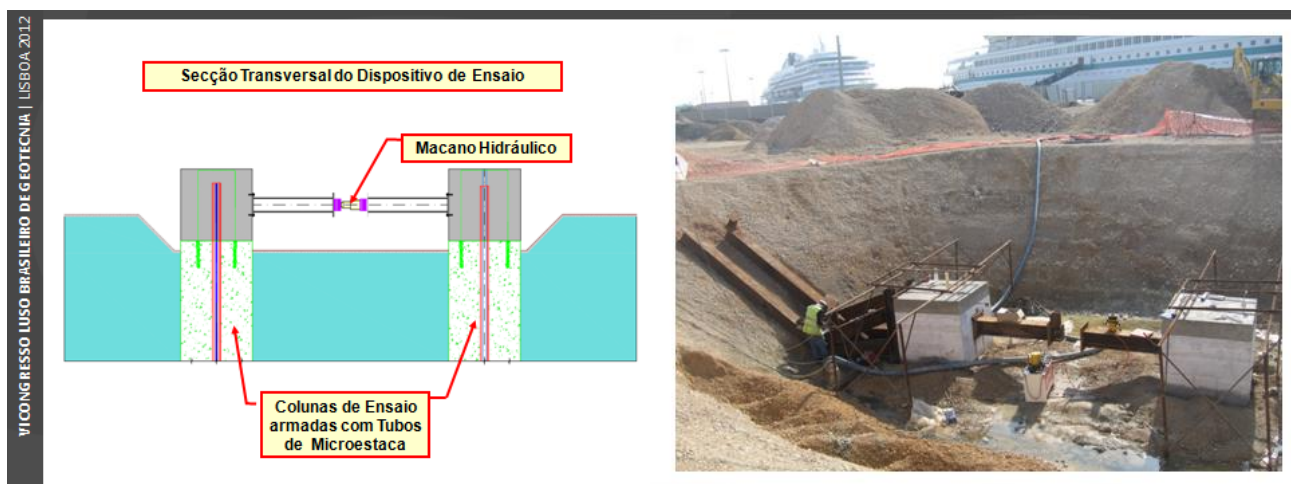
Sistema de Ensaio Idealizado e Sistema Alternativo Implementado
